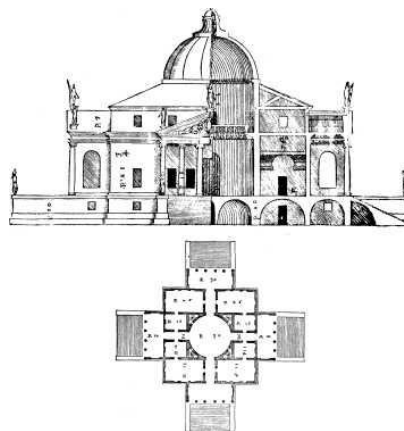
Villa Rotonda, Andrea, Planta e corte
